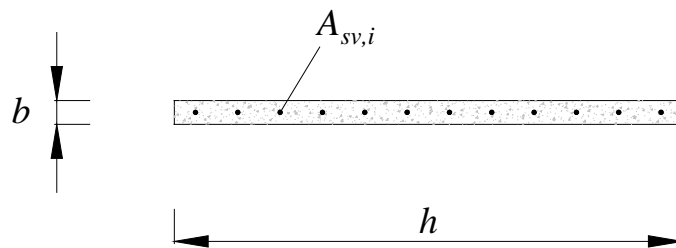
Sezione in c.c.a. di forma rettangolare $b \times h$ caratterizzata da una serie di barre verticali di armatura tutte dello stesso diametro ed equidistanti tra loro (sezione ad armatura diffusa).
